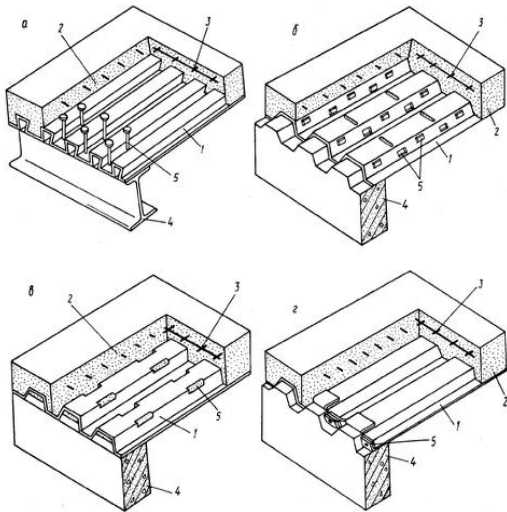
Сталежелезобетонная конструкция четвертого типа (с несъемной опалубкой):
